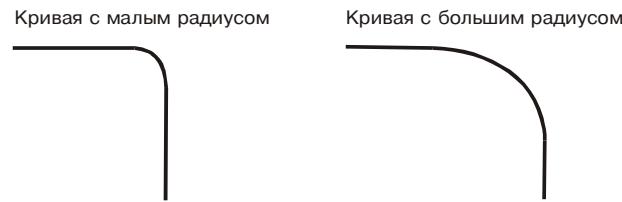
Элементы плана трассы - кривые в плане
